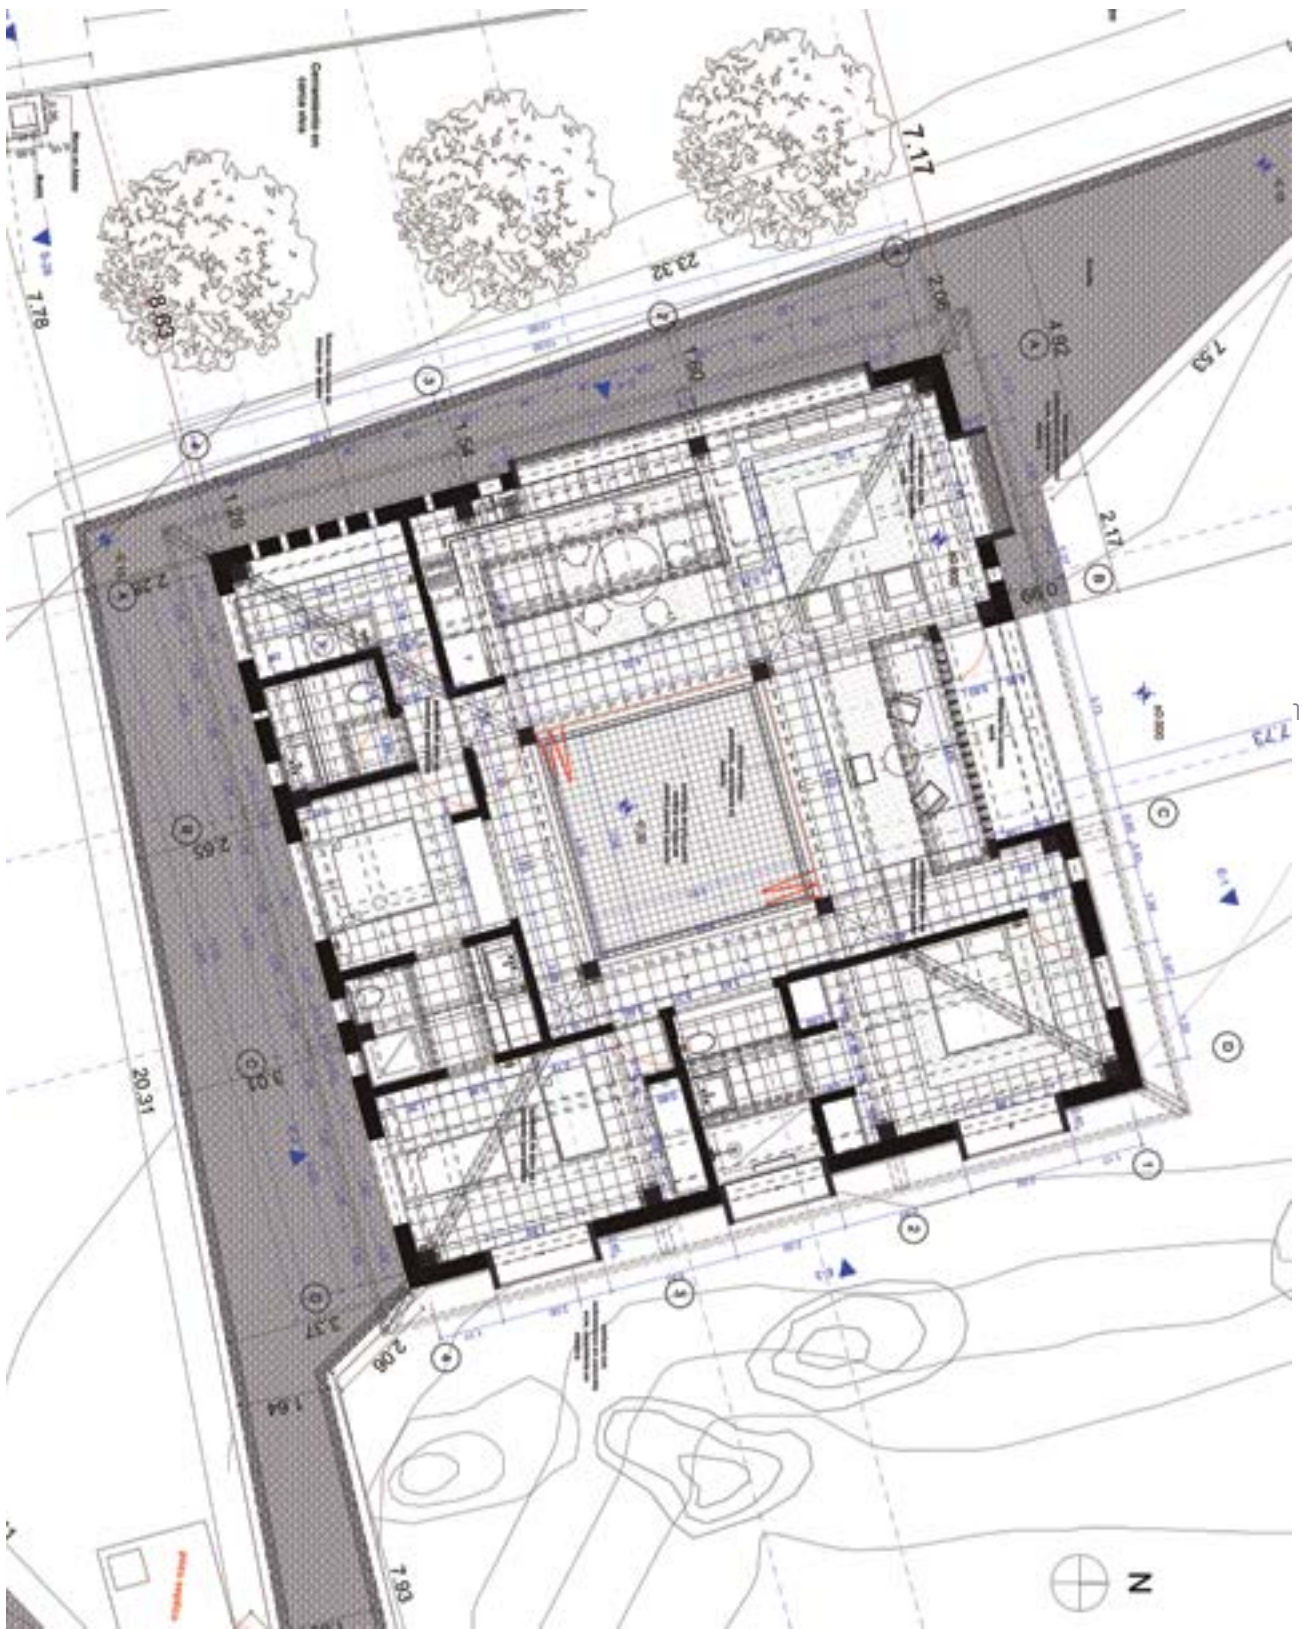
Planta casa en Dordoña. Fuente: Lacaton & vasal Revista el croquis # 177-178.
